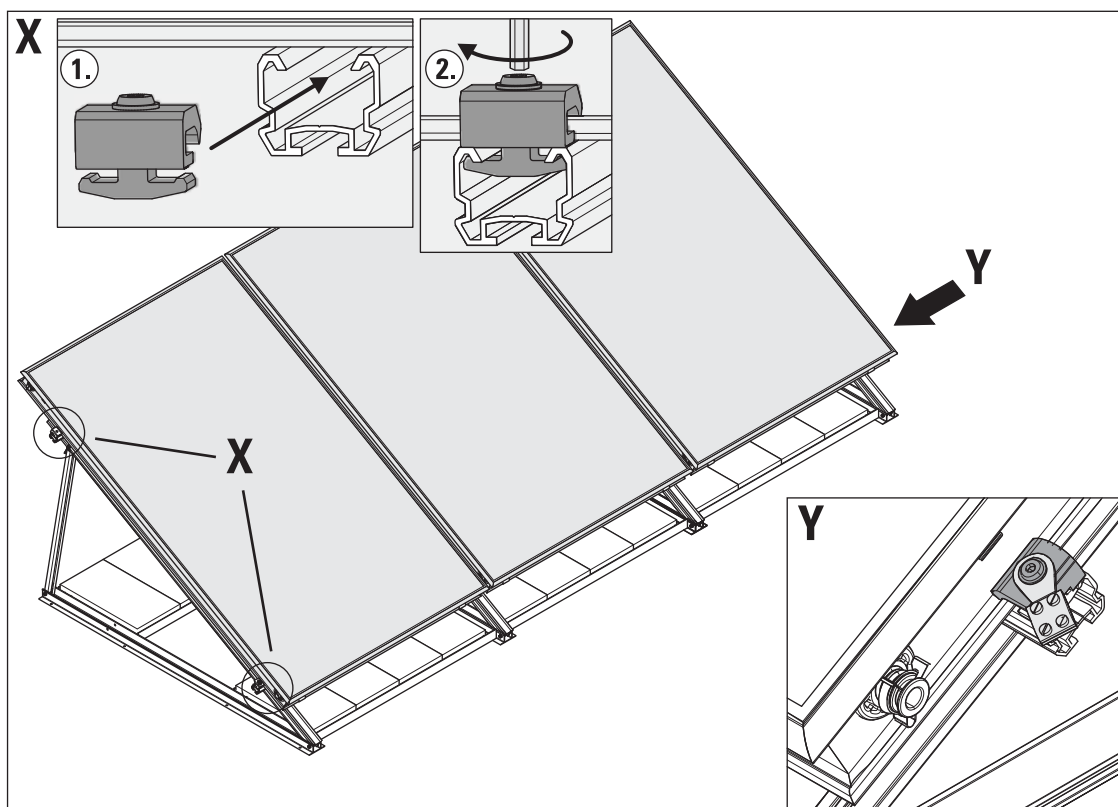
Einzelklemmsteine für den letzten Flachkollektor einsetzen und festschrauben. Klemmstein mit Potentialausgleichsklemme in der Nähe des Rücklaufanschlusses montieren.
